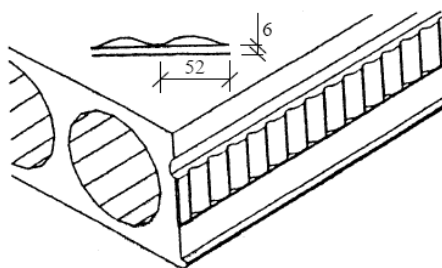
Junta ondulada de lajes alveoladas (extraída de [28])
